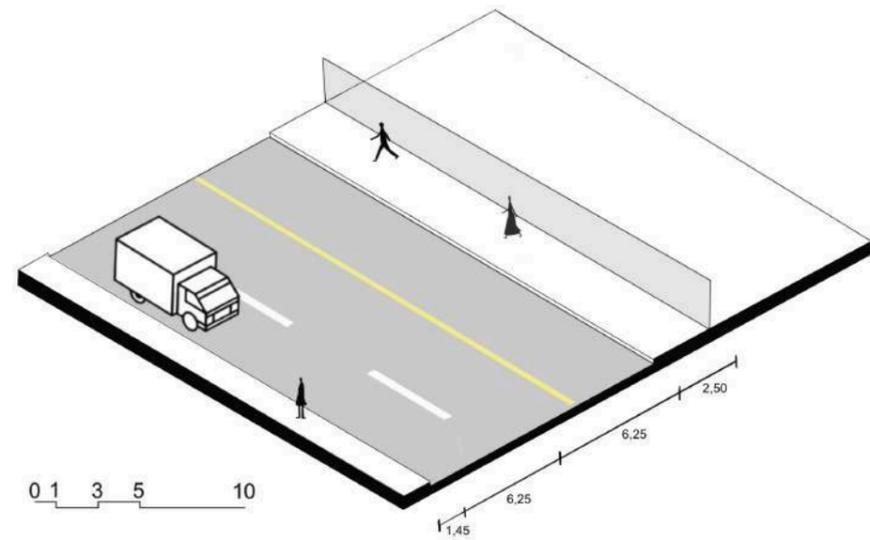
Calle Sebastián de Benalcázar sección actual. Fuente propia.
